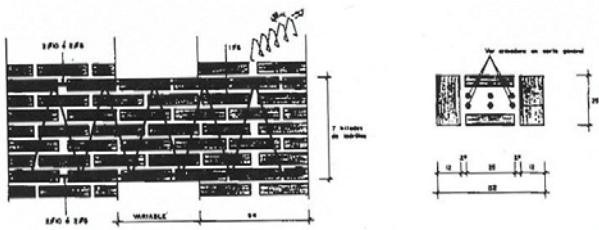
Detalhe dos travamentos em alvenaria armada e das linhas contínuas verticais que fazem pilares. Usaram-se estribos horizontais e estribos em espiral. (*-1).
